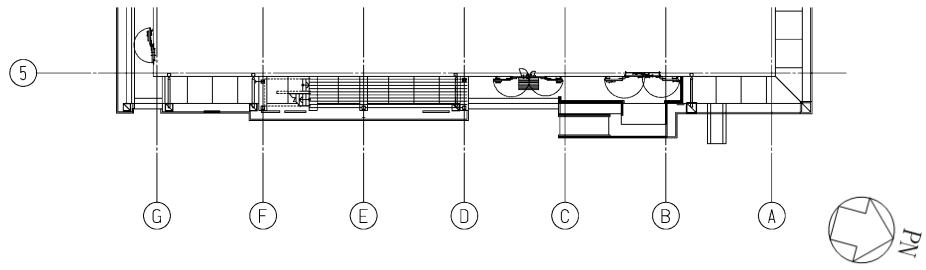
(1) 免震重要棟鋼製バルコニーの1階平面図
